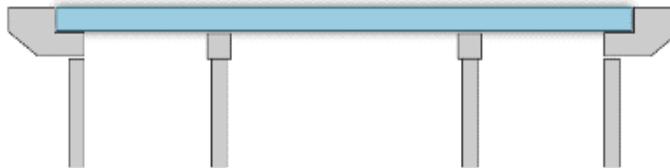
Ejemplo de puente tipo viga con tramos continuos.
